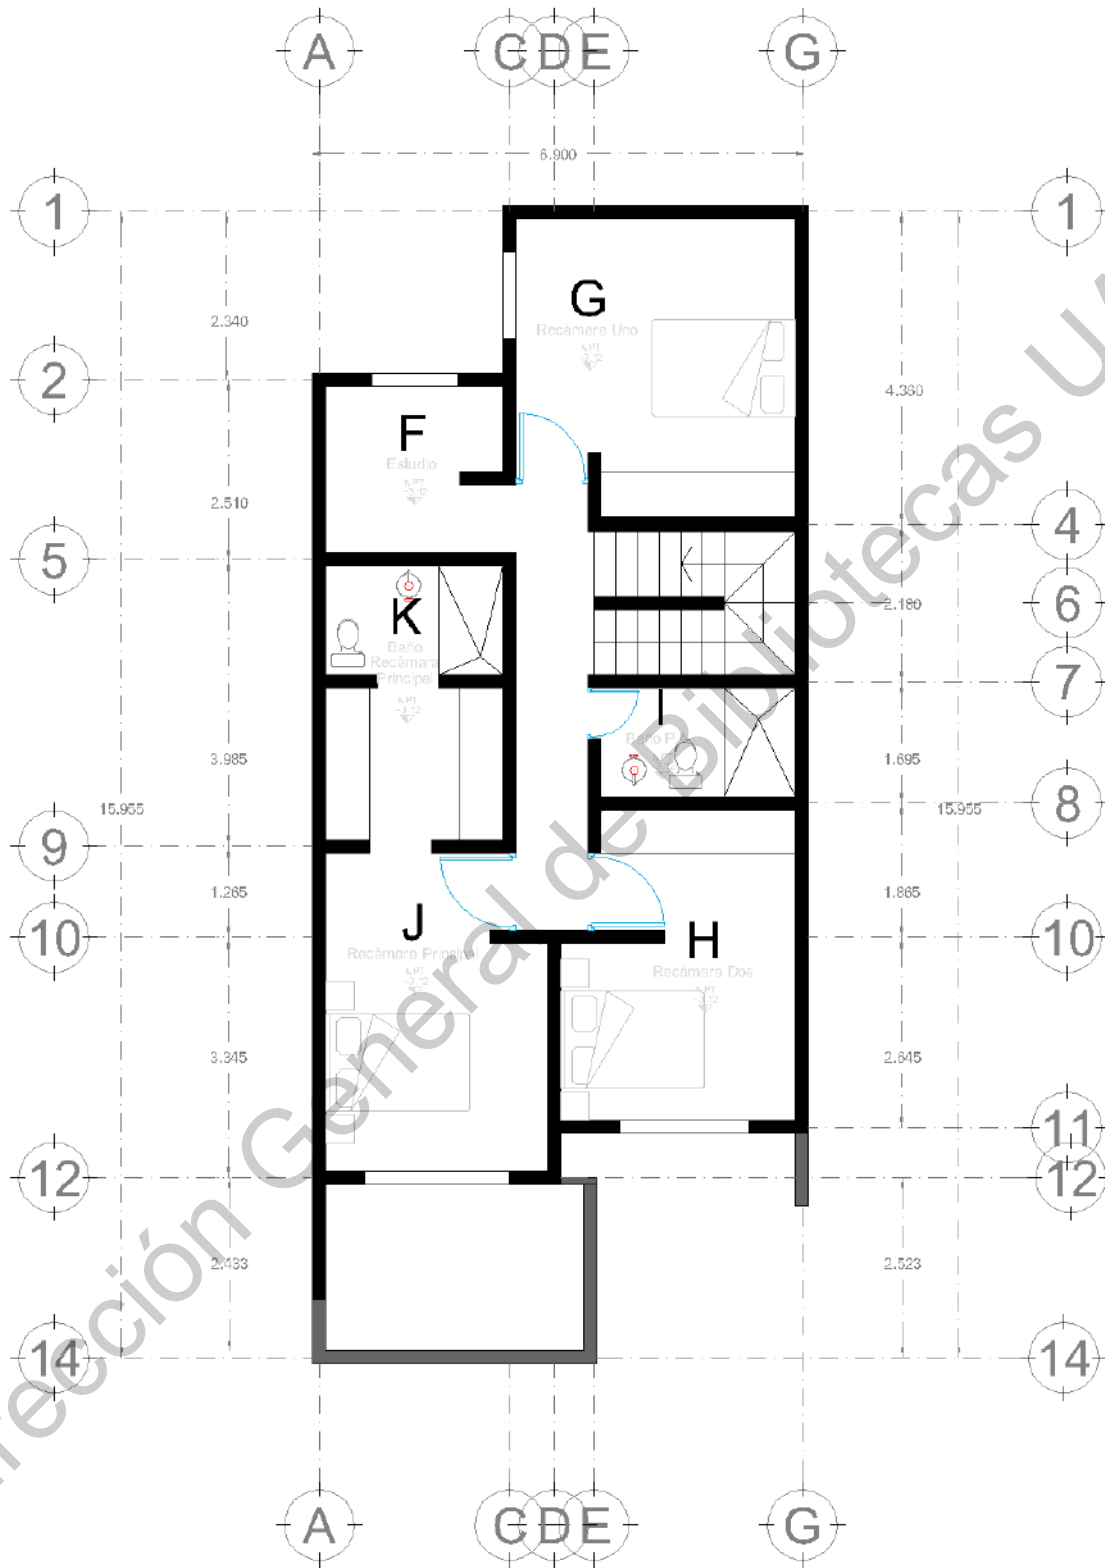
Planta Arquitectónica Alta. Casa Ixtlán.
